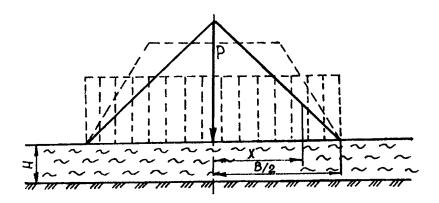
Схема к расчету устойчивости насыпи на слабом основании
